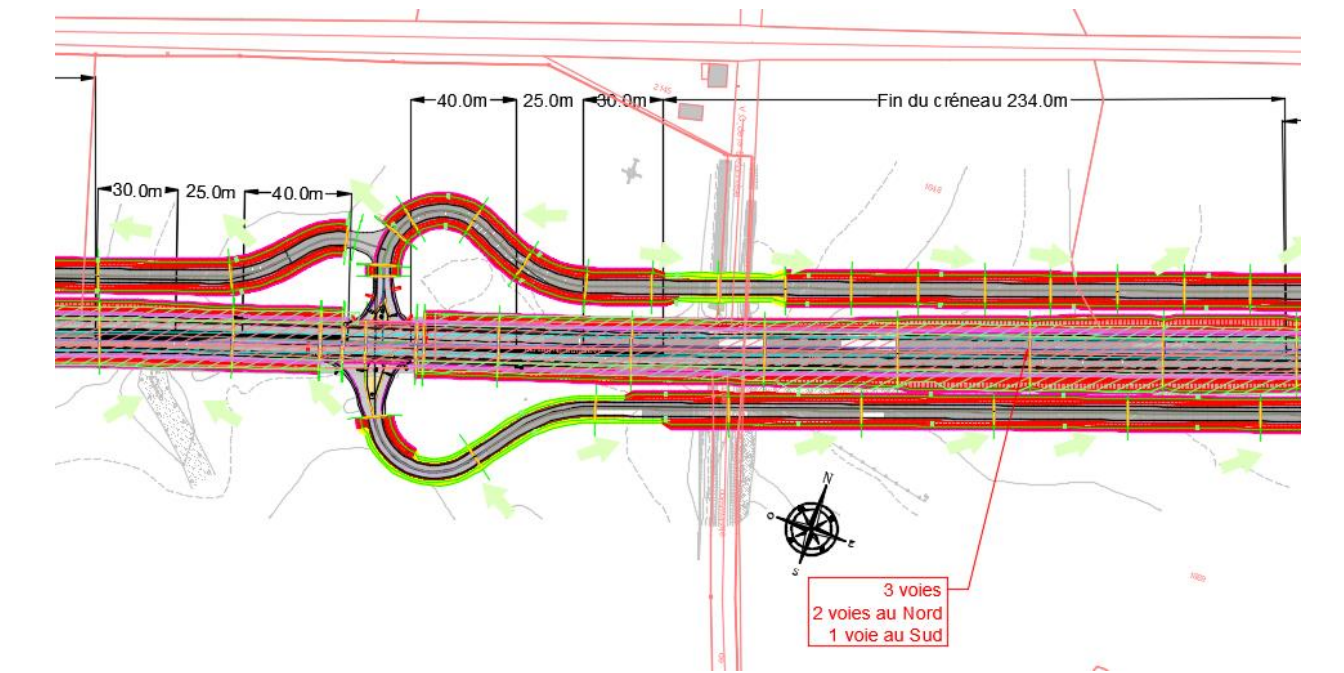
Plan du carrefour de Saint Eugène - Section 2
